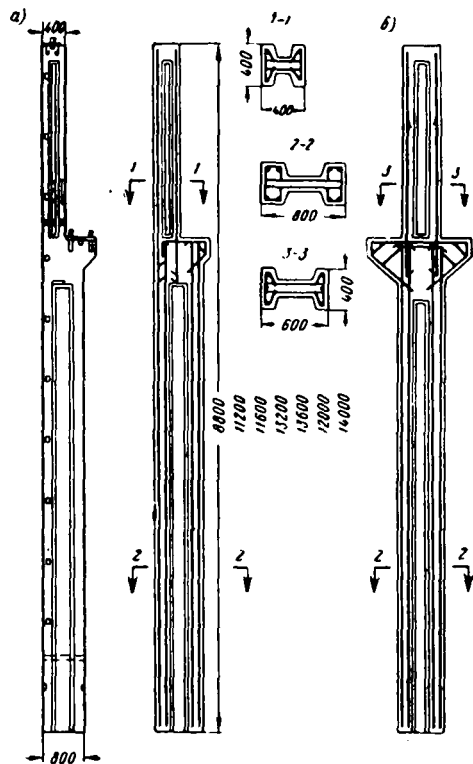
Колонны двутаврового сечения серии КЭ-01-09 для зданий с мостовыми кранами
